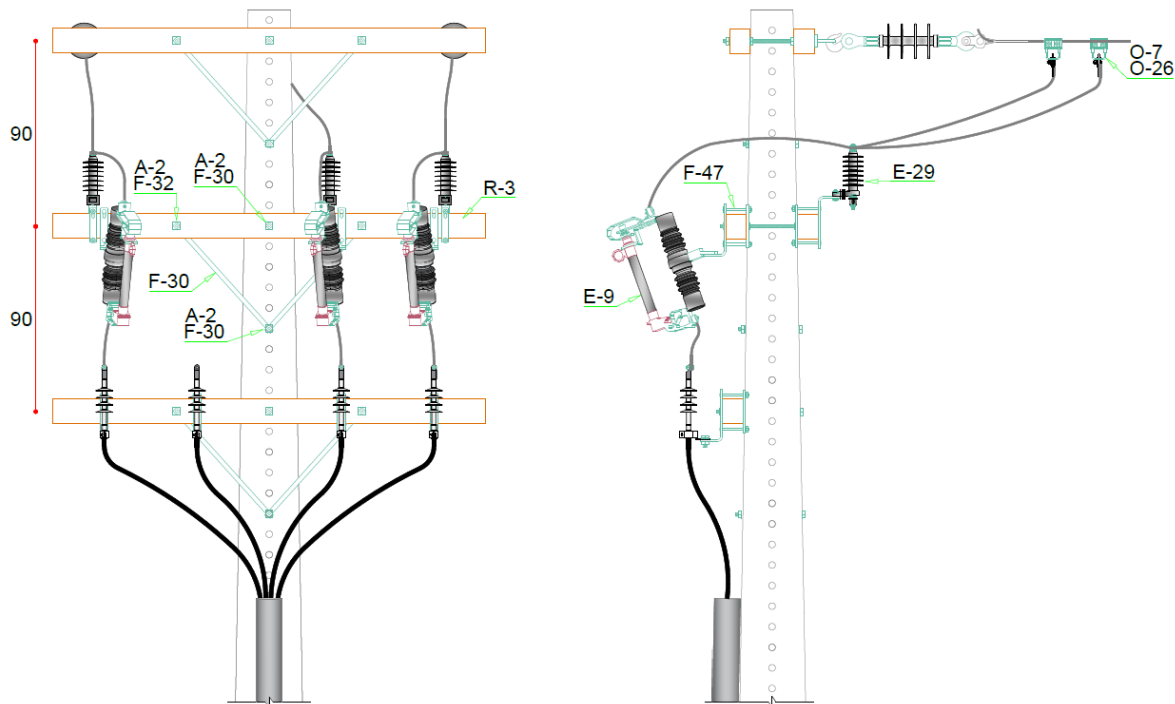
Ramal Subterrâneo Simples em Estrutura N3
